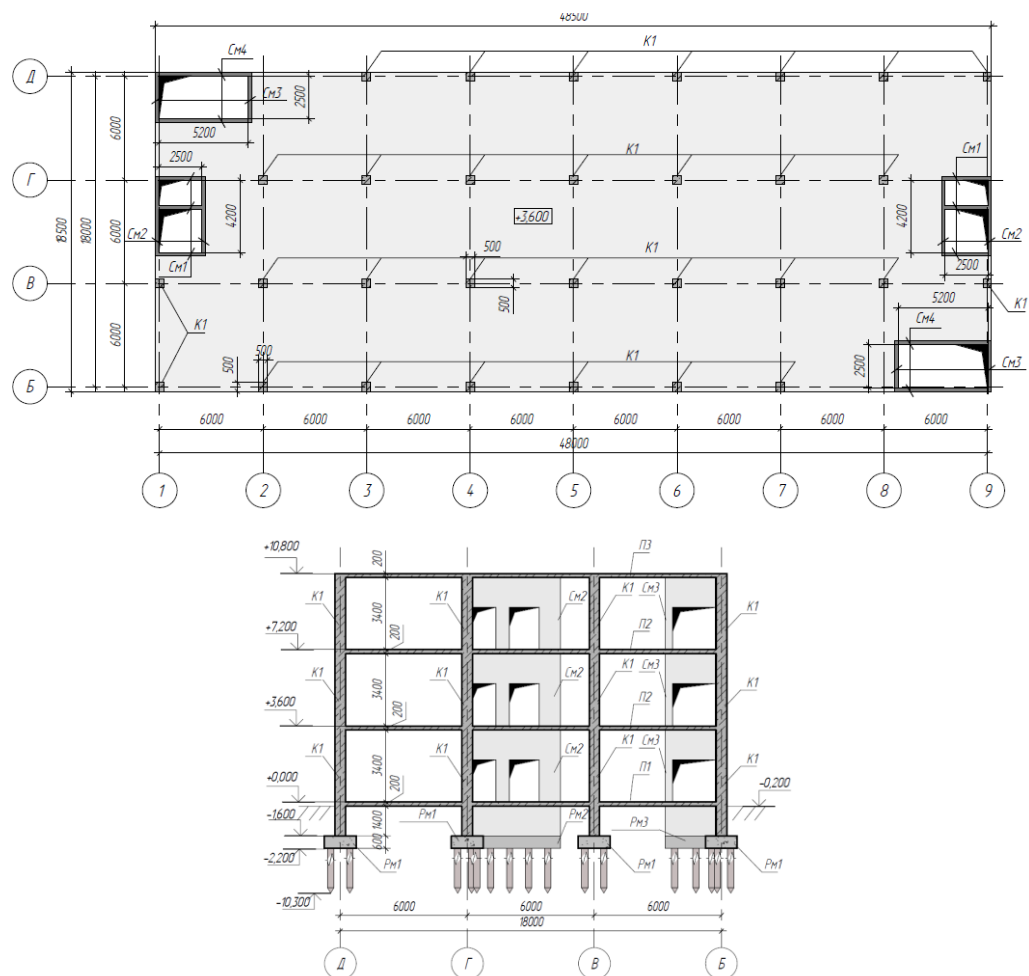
План на отметке плюс 3,600 и разрез здания по оси 2
